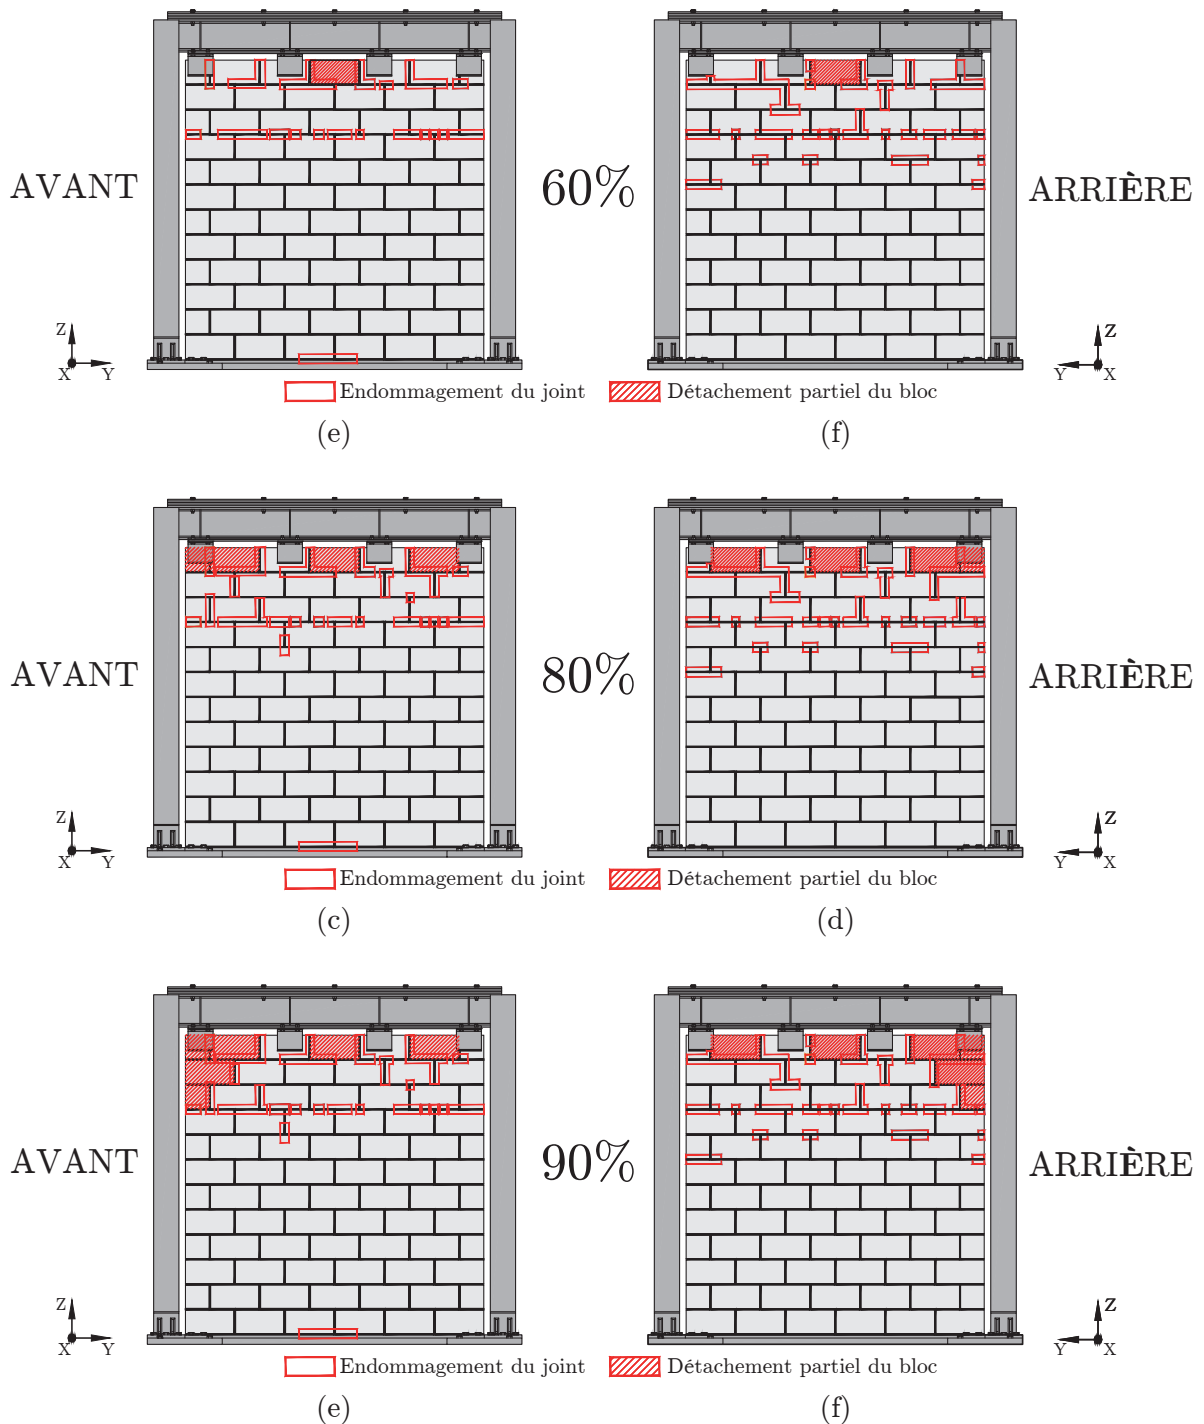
Représentation visuelle de l'endommagement du mur 1 après l'essai (a) MAL15-0.60 - façade avant (b) MAL15-0.60 - façade arrière (c) MAL17-0.80 - façade avant (d) MAL17-0.80 - façade arrière (e) MAL18-0.90 - façade avant (f) MAL18-0.90 - façade arrière
